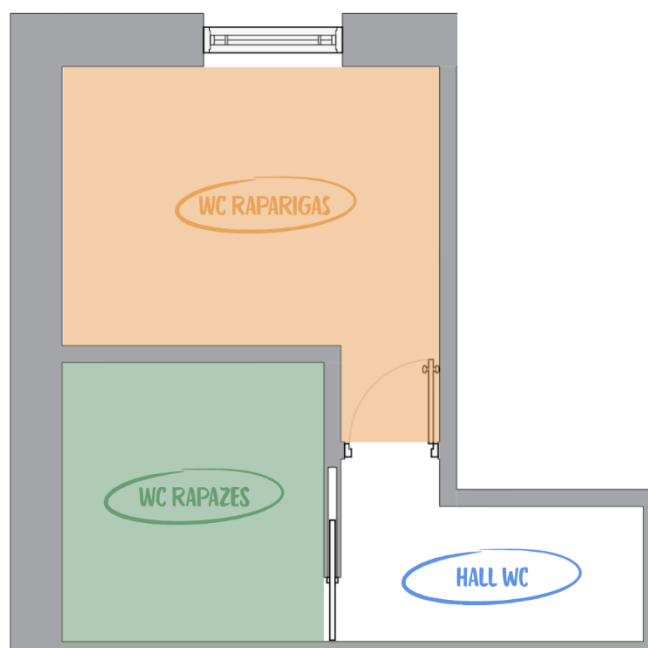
Proposta final do layout das casas de banho do 2º piso. *Fonte: Autora.
